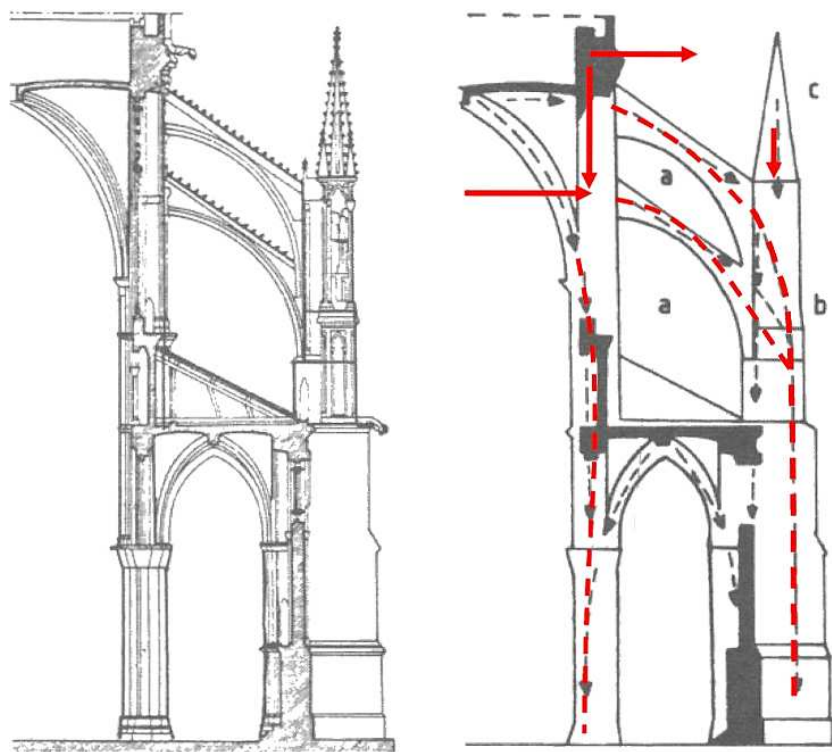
Esquema de la mitad de la sección transversal de una catedral de estilo gótico. (Imagen tomada de [Hormigón estructural 2005, 18]).
